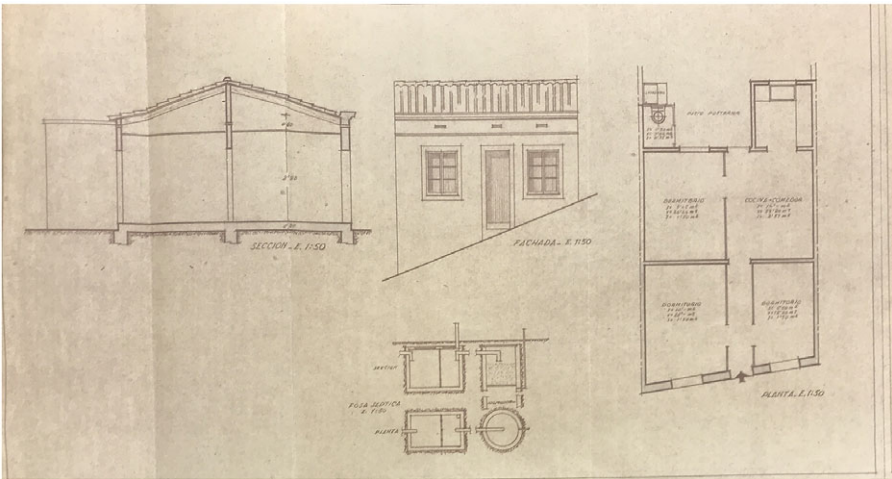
Passatge del Dipòsit 11, first design by F. Sanllehi Pont (1953) as a single-storey building (AMCB Q-132, 49471).
